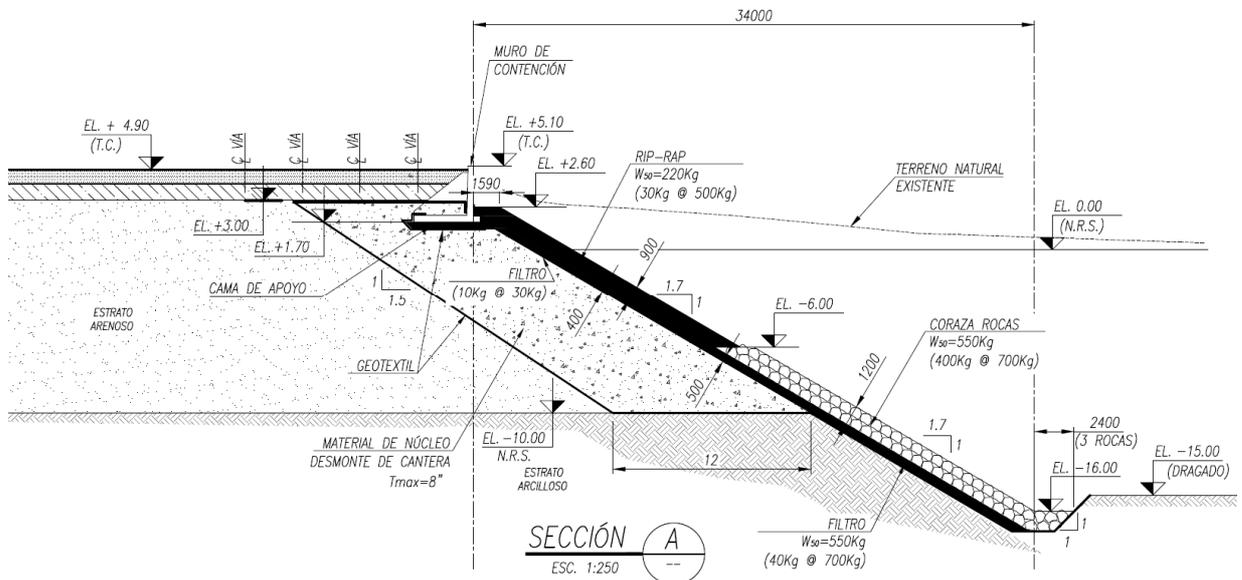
Perfil Protección Fondo de Poza Enrocado + Muro de Contención
